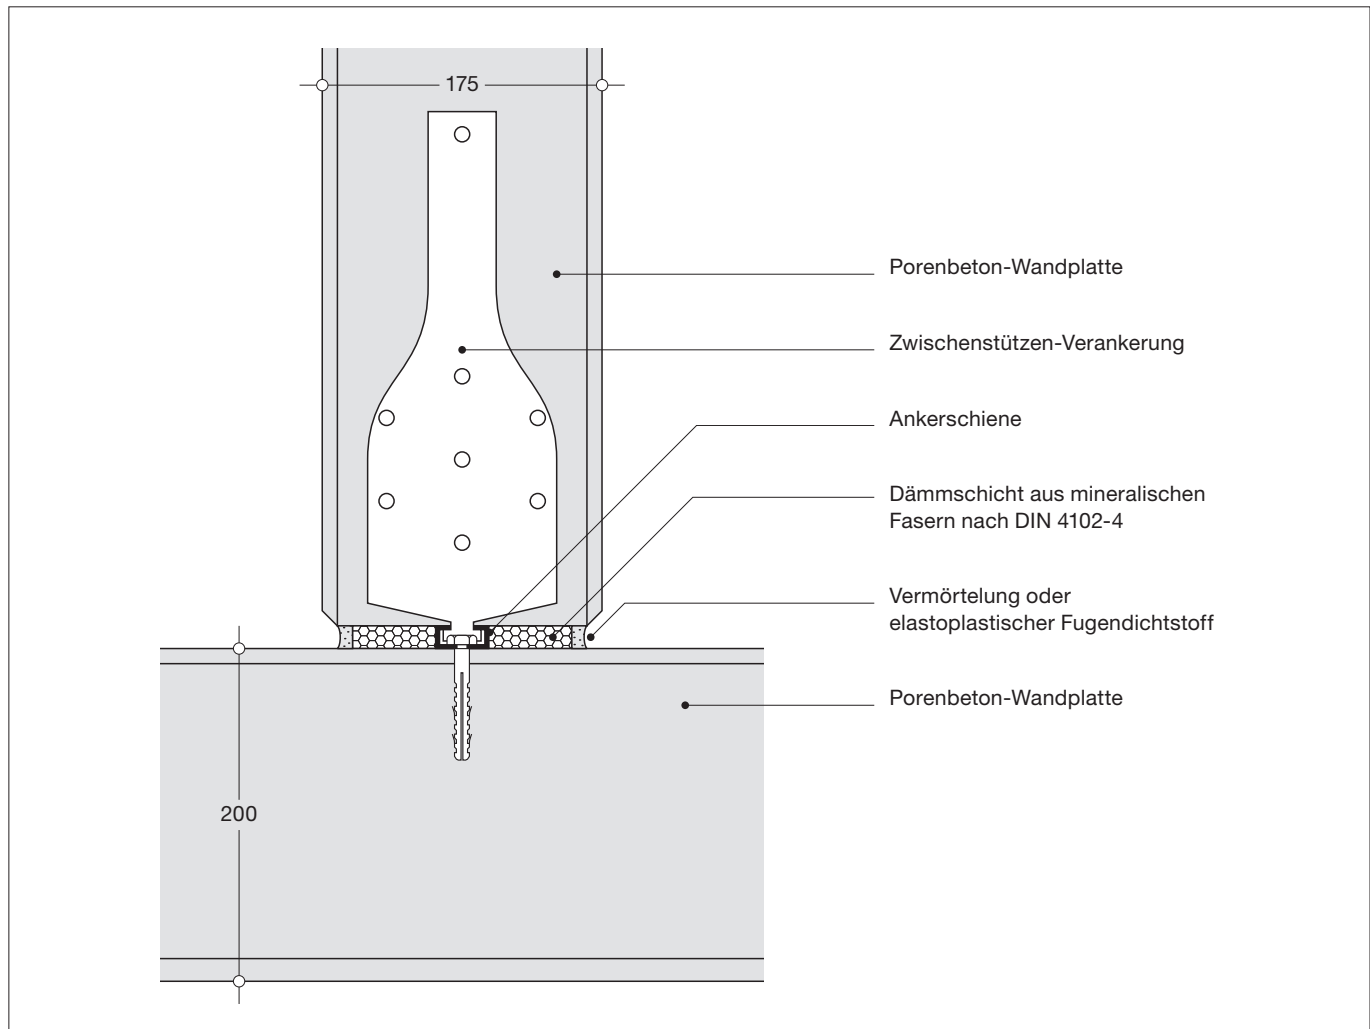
Nachgewiesener, standsicherer Plattenanschluss bei Brandwänden (Anschluss Wand-Wand) bis zu Klasse F 90-A
